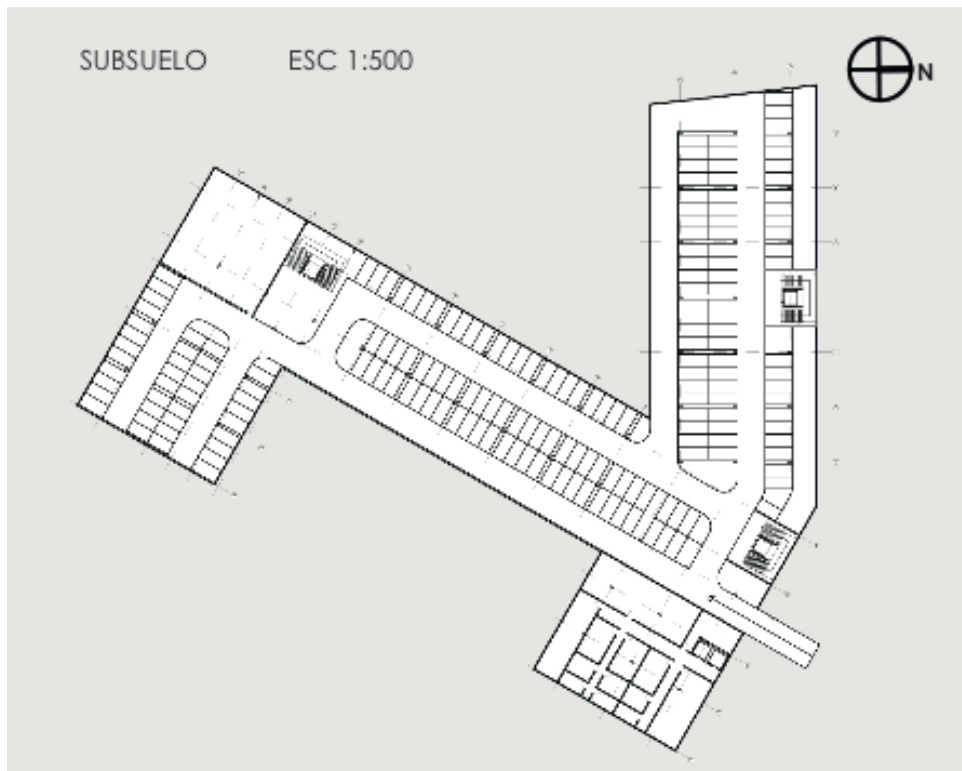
PLANTA DE SUBSUELO (Elaboración Propia)
